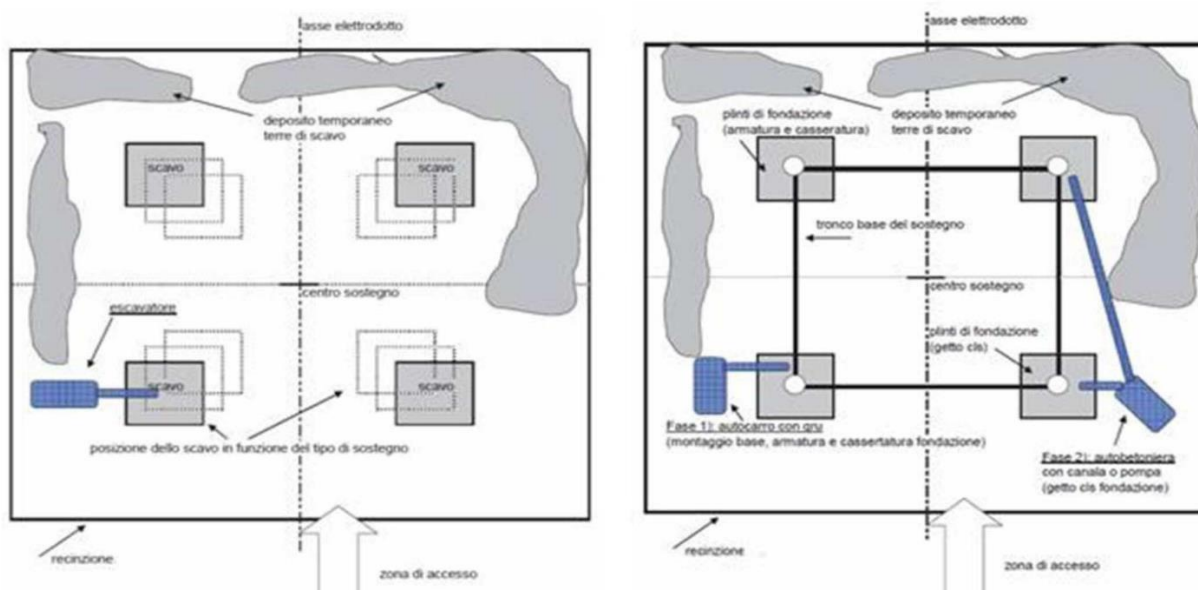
Planimetria tipologica di un microcantiere per una fondazione superficiale: a sinistra nella fase di scavo delle fondazioni; a destra nella fase di getto per la realizzazione dei plinti di fondazione.
